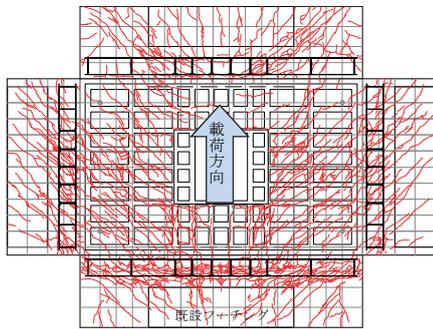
ひび割れ進展状況（実験，最大荷重=1,557kN）
